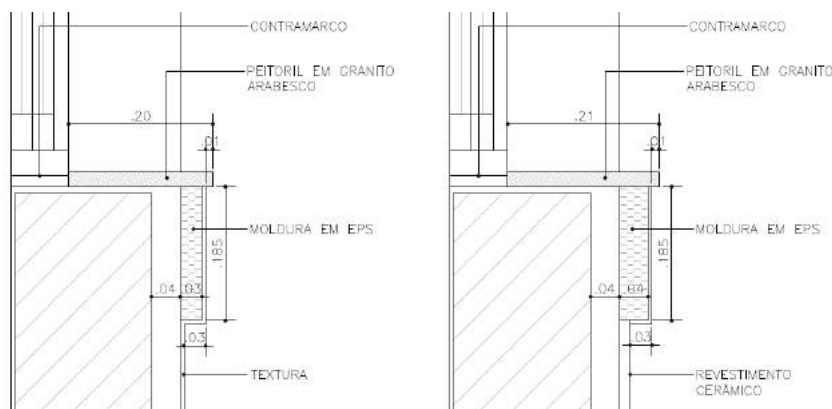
Elemento de EPS na fachada - Croqui elaborado pelo Departamento de Projetos
